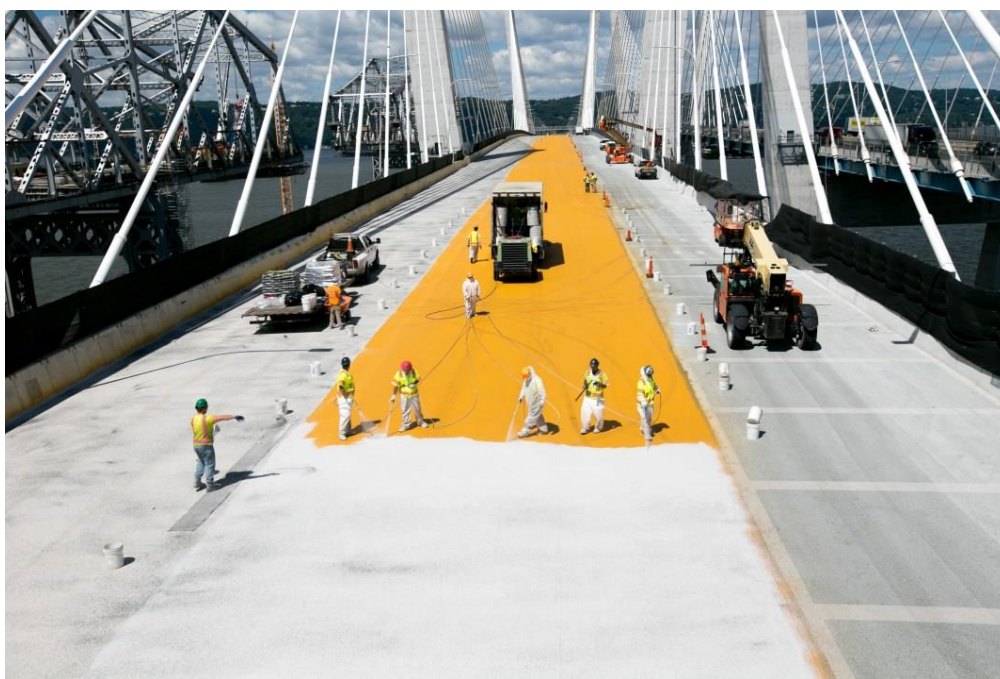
Использование двухцветной системы укладки гидроизоляции
